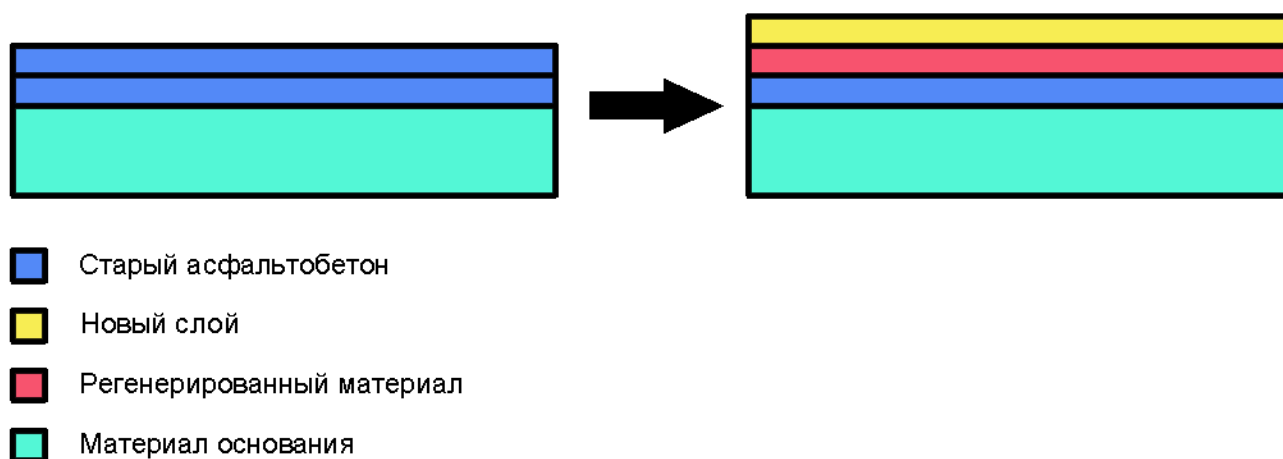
Схема проведения капитального ремонта дорожного асфальтобетонного покрытия с его восстановлением способами горячей регенерации
